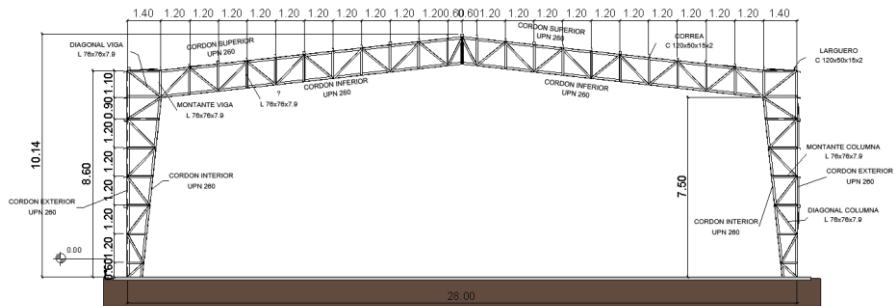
Vista pórtico tipo. Fuente: Elaboración propia.
